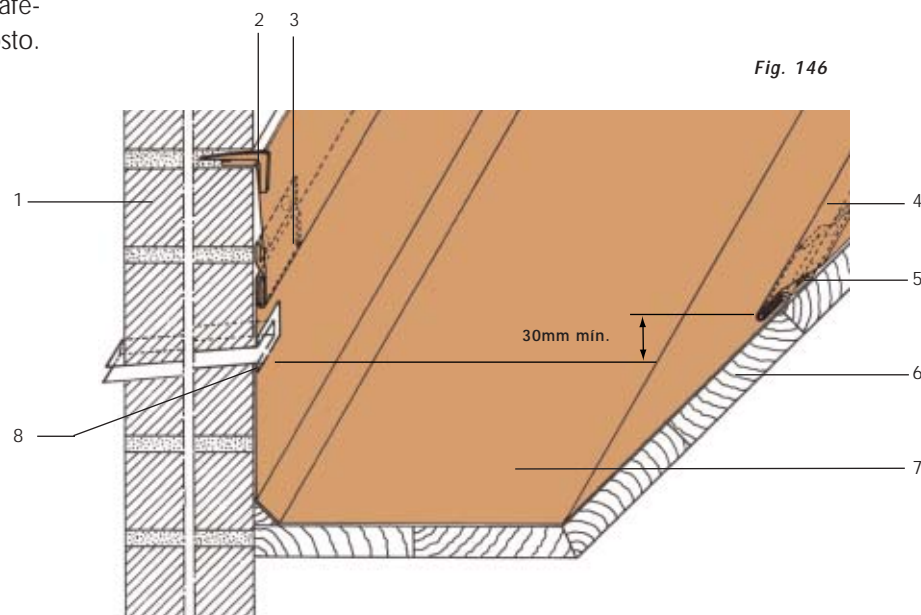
Variante de tipo calha - junto à parede (testeira).
